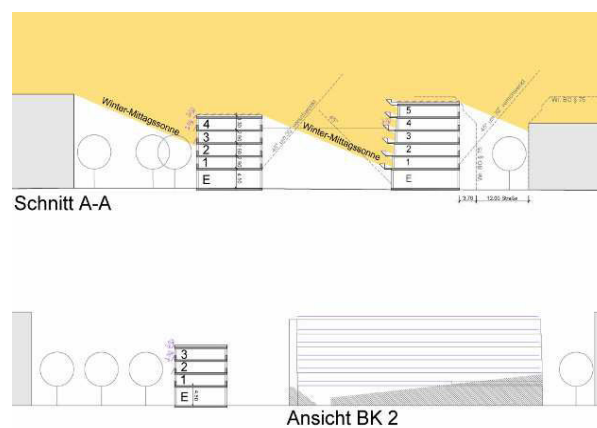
Wohnen: Schnitt, Fassadenansicht mit Beschattung
